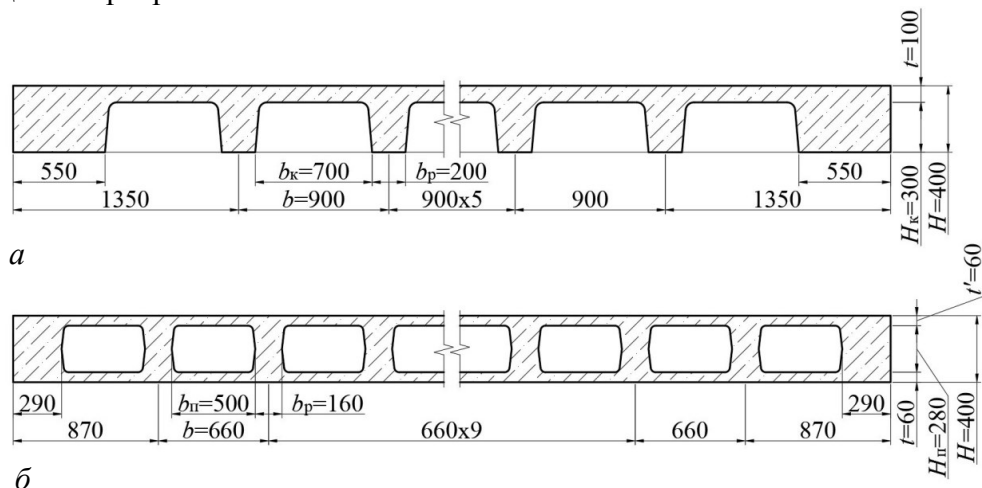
Поперечное сечение монолитного перекрытия: а – кессонного; б – многопустотного
